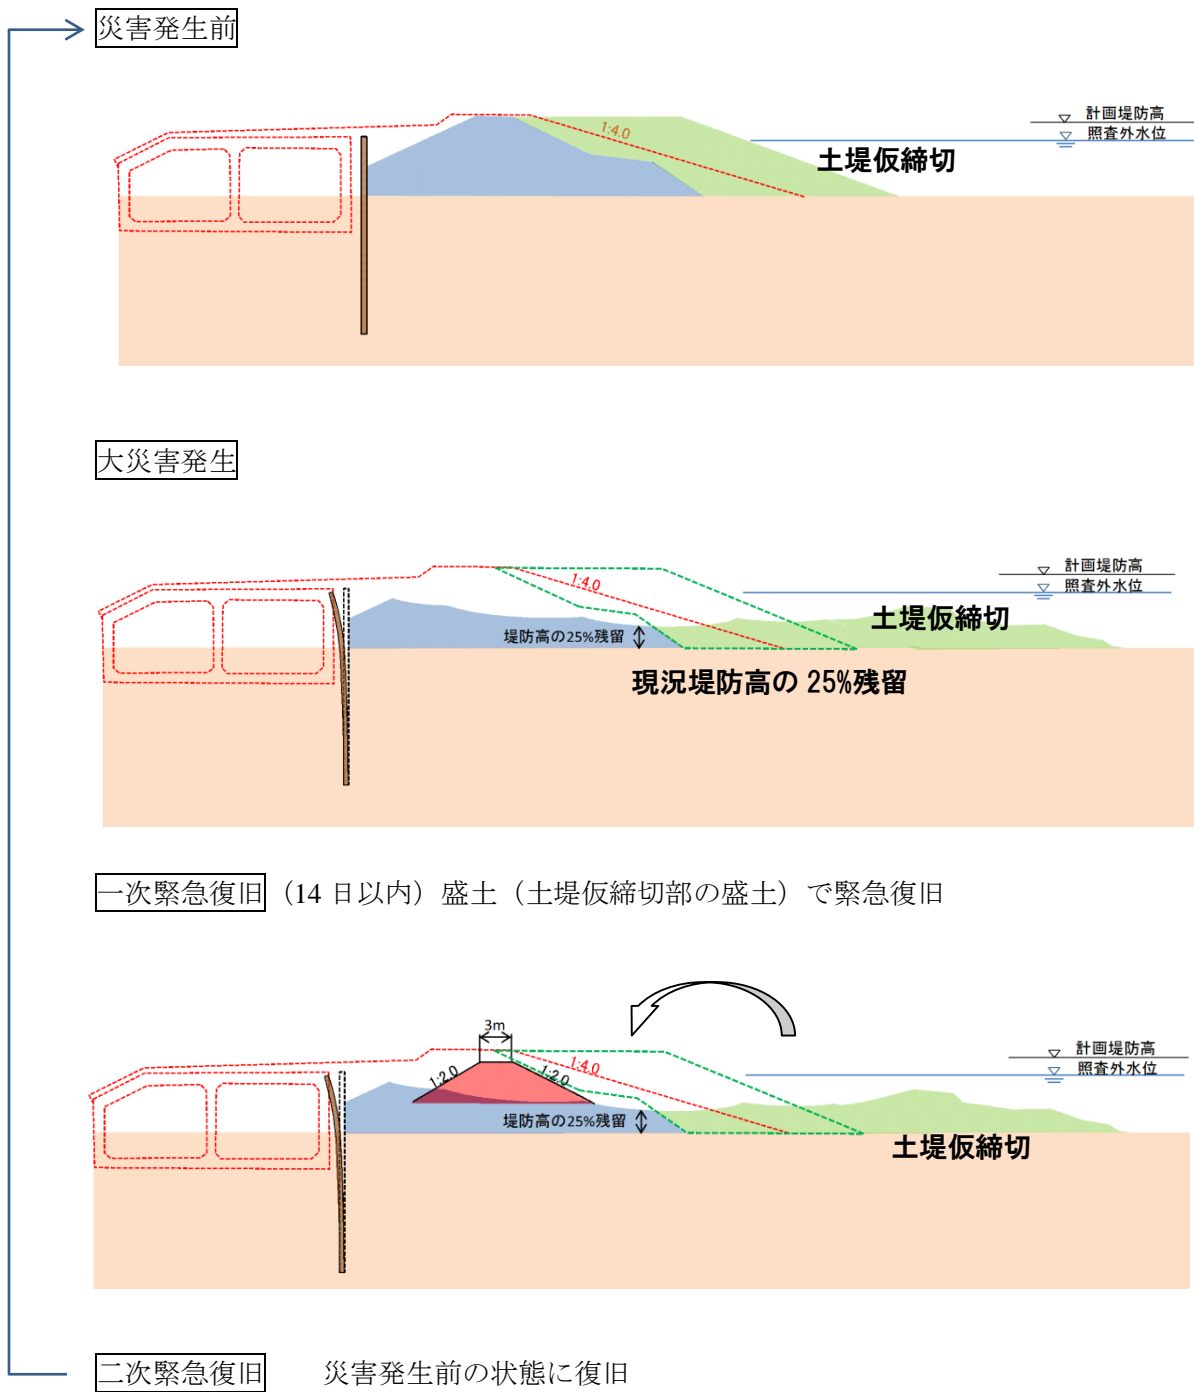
緊急復旧シナリオ（施工タイプ B1, B2）
